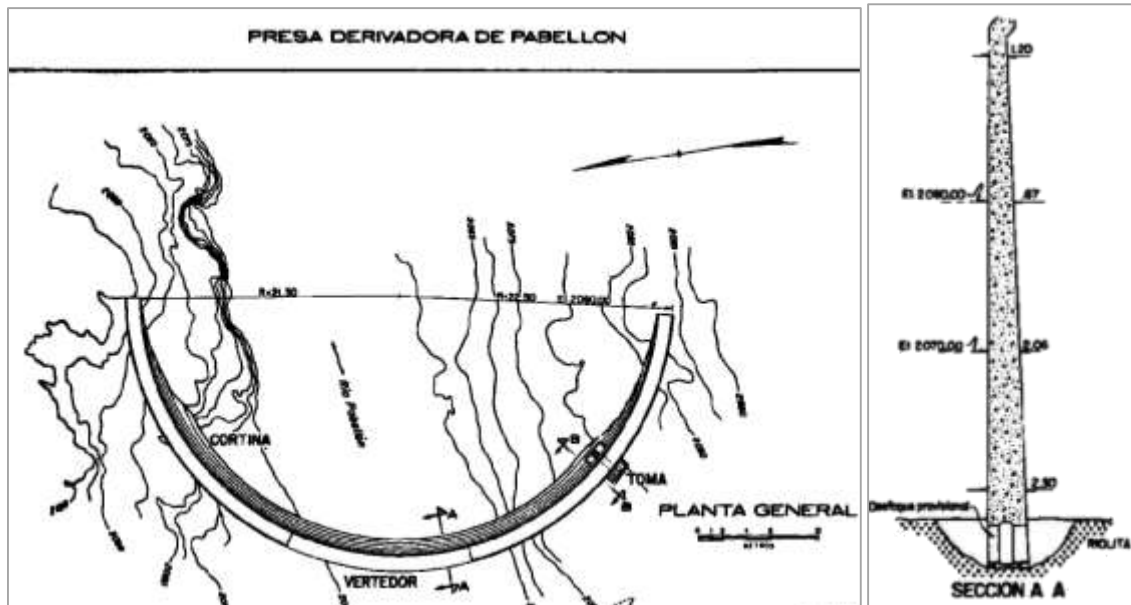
Plano del vertedor de descarga libre de la Presa Derivadora Pabellón, Ags., CNA.
